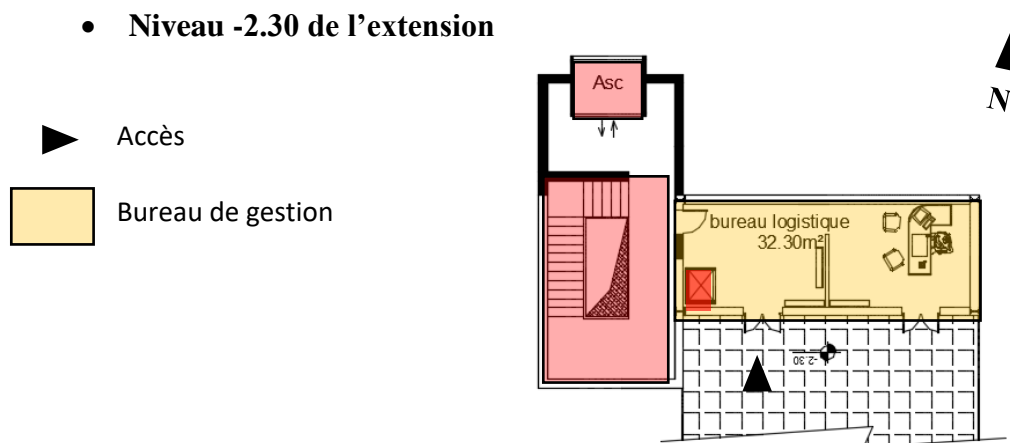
plan du niveau -2.30 – Source : Auteur Auteur
